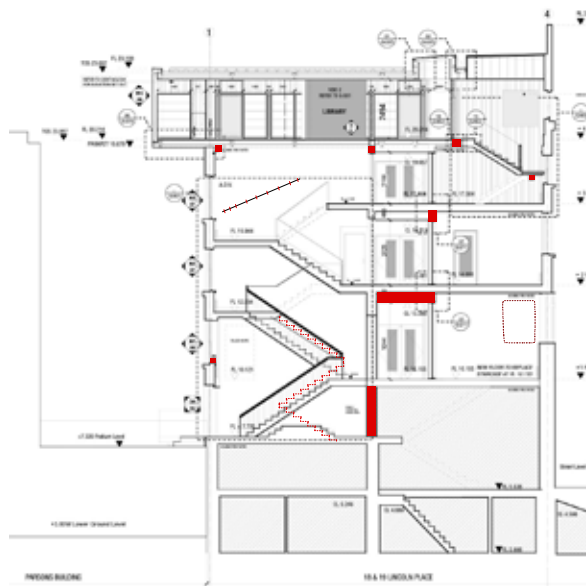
Strukturschnitt © McCollough Mulvin Architects
